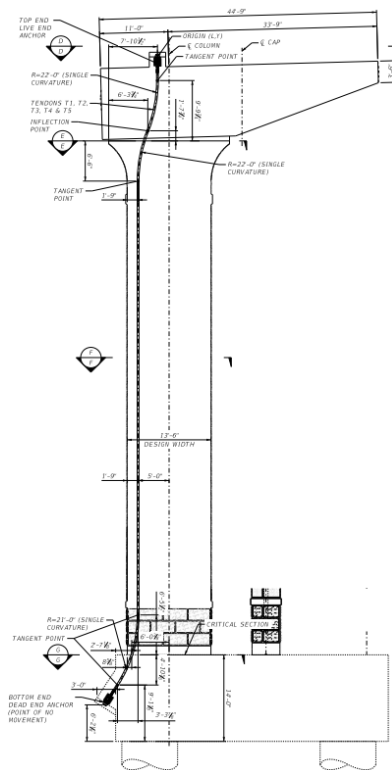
Trazado del pretensado de la pila 18 del puente 113B.
